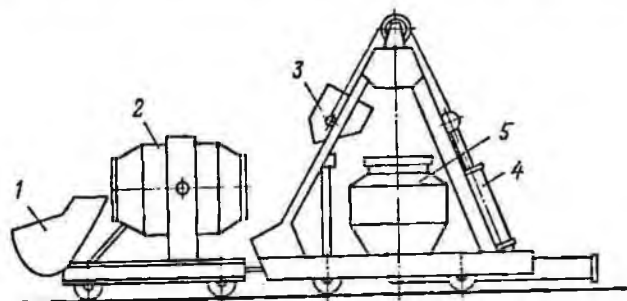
Схема бетоноукладочного комплекса фирмы «Швинг»
